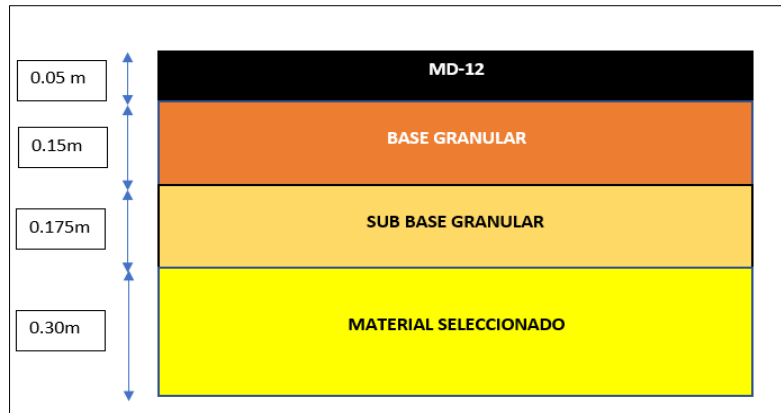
Estructura Pavimento con materiales pétreos. Estructura 2.
